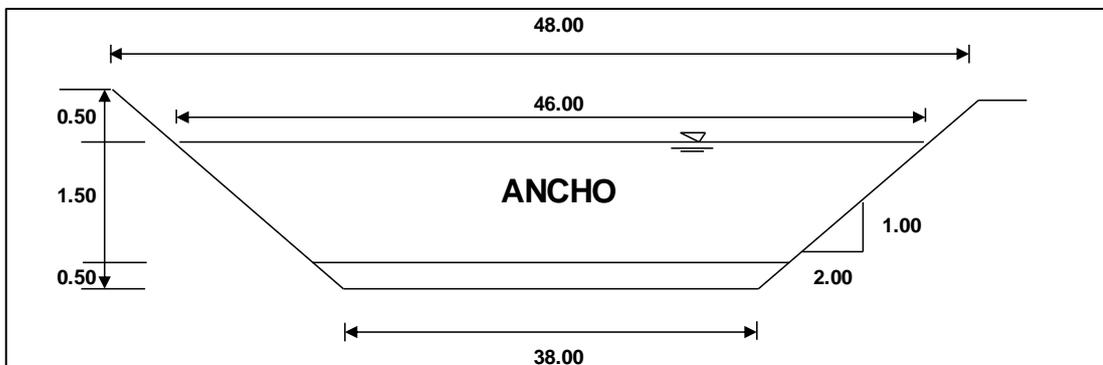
Sección transversal a lo ancho de la laguna de oxidación primaria proyectada.
